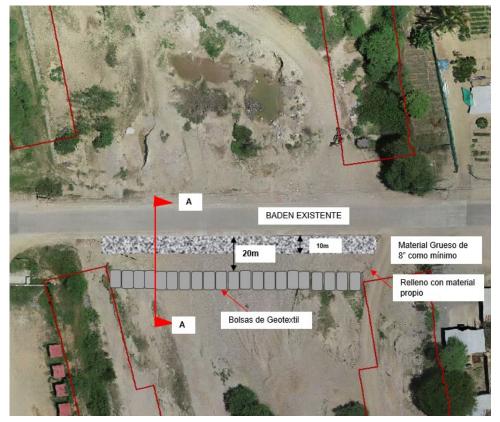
Vista en planta de las obras de protección aguas abajo del baden.
